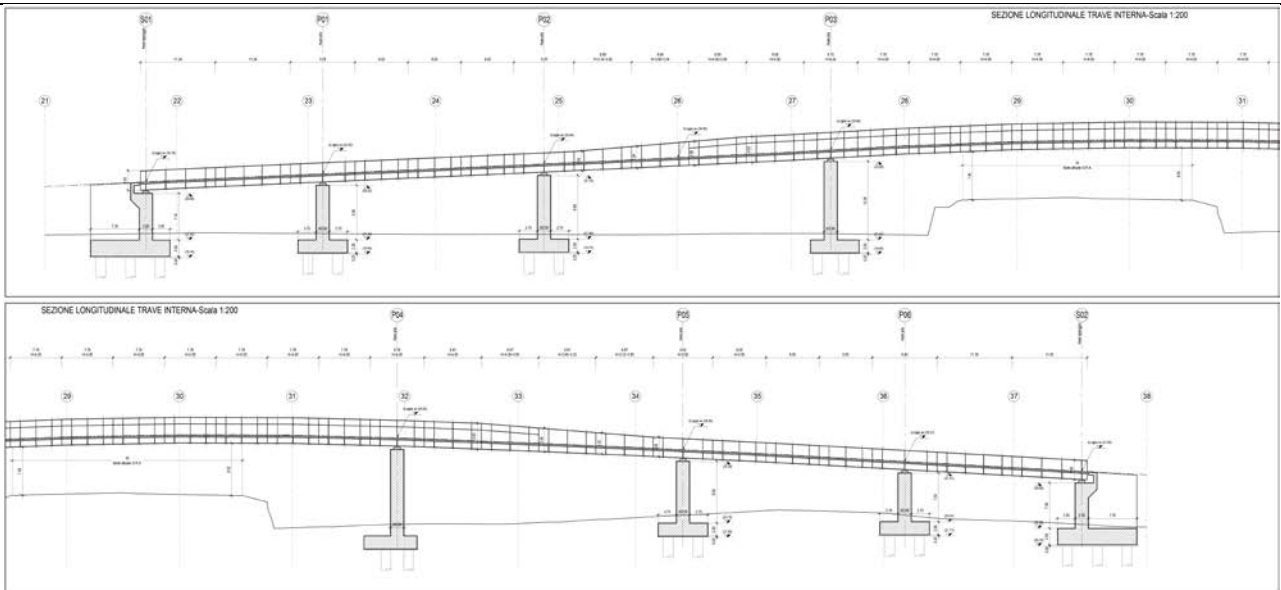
Viadotto "Rampa di inversione sud": sezione longitudinale trave interna
